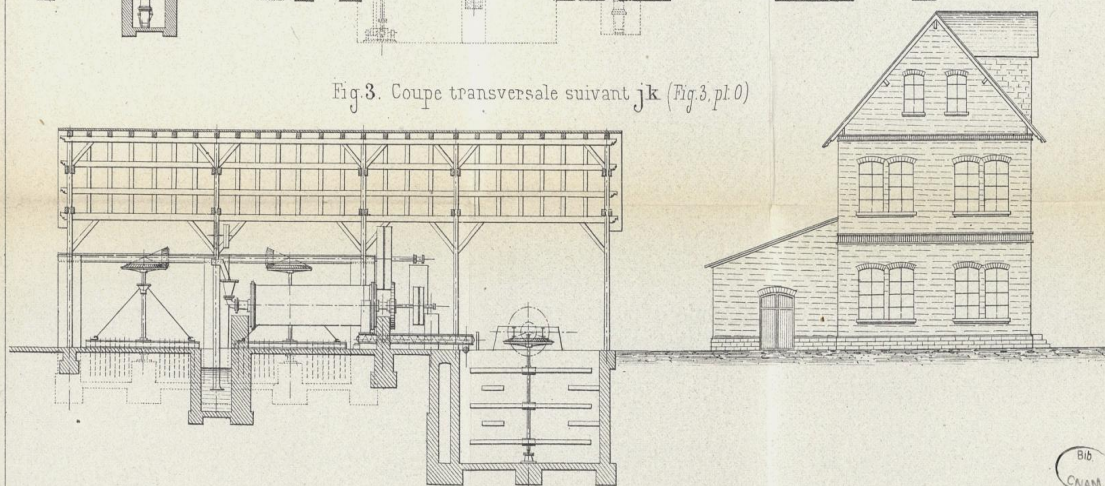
Coupe transversale suivant jk (Fig.3. pl.0)
